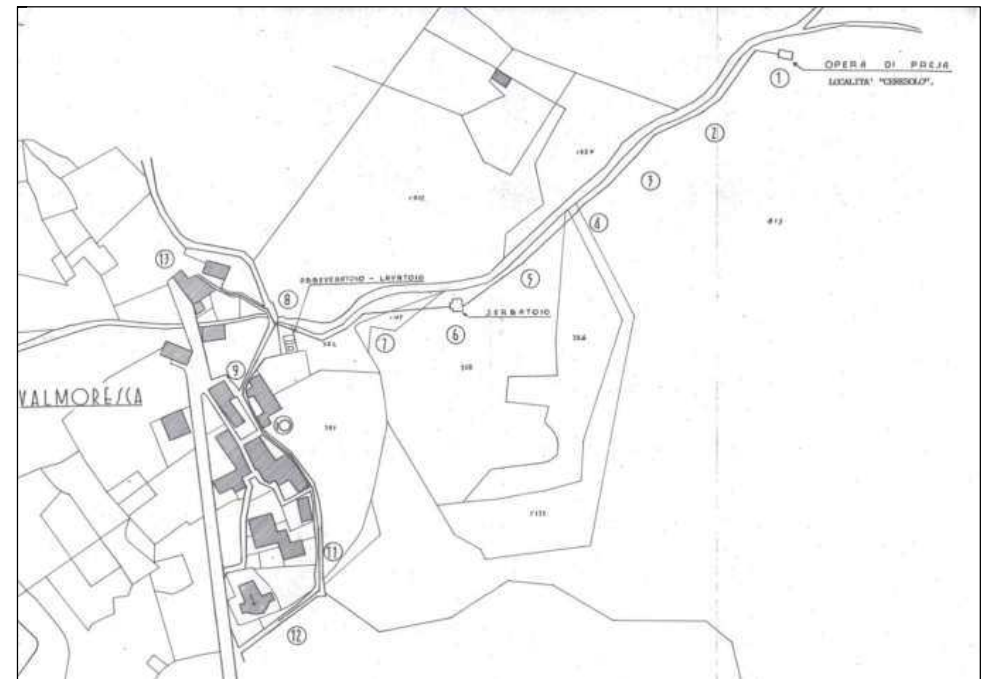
Planimetria generale acquedotto rurale – frazione Valmoresca
